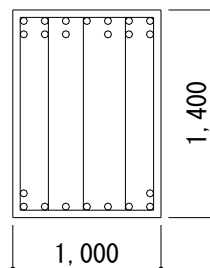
鉄筋コンクリート大梁の配筋図 (R階, 3通り, B～C通り間) (単位：mm)
